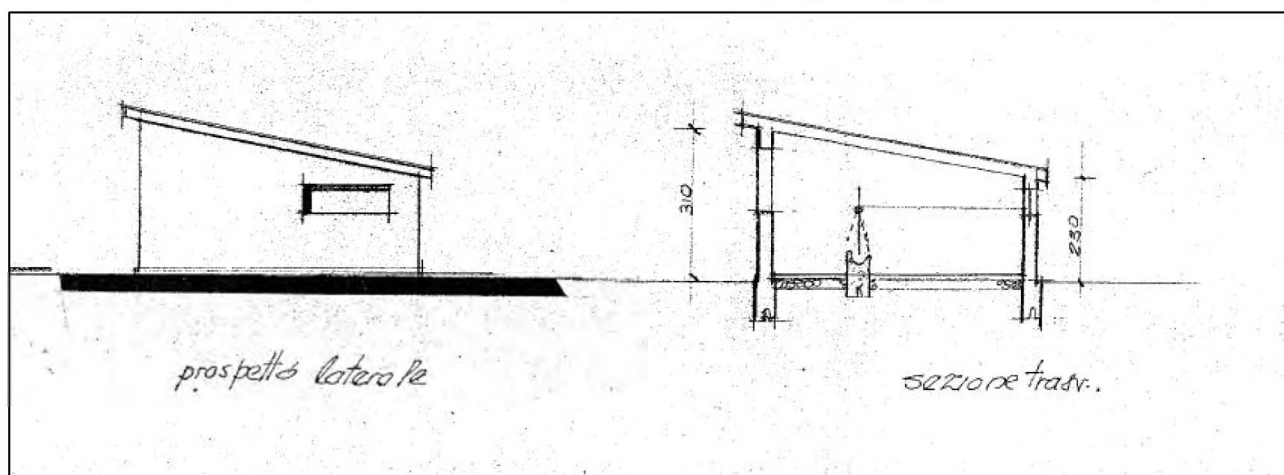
Sezione e prospetto laterale stalla - Licenza a costruire in variante n. 24bis del 18.07.1973
